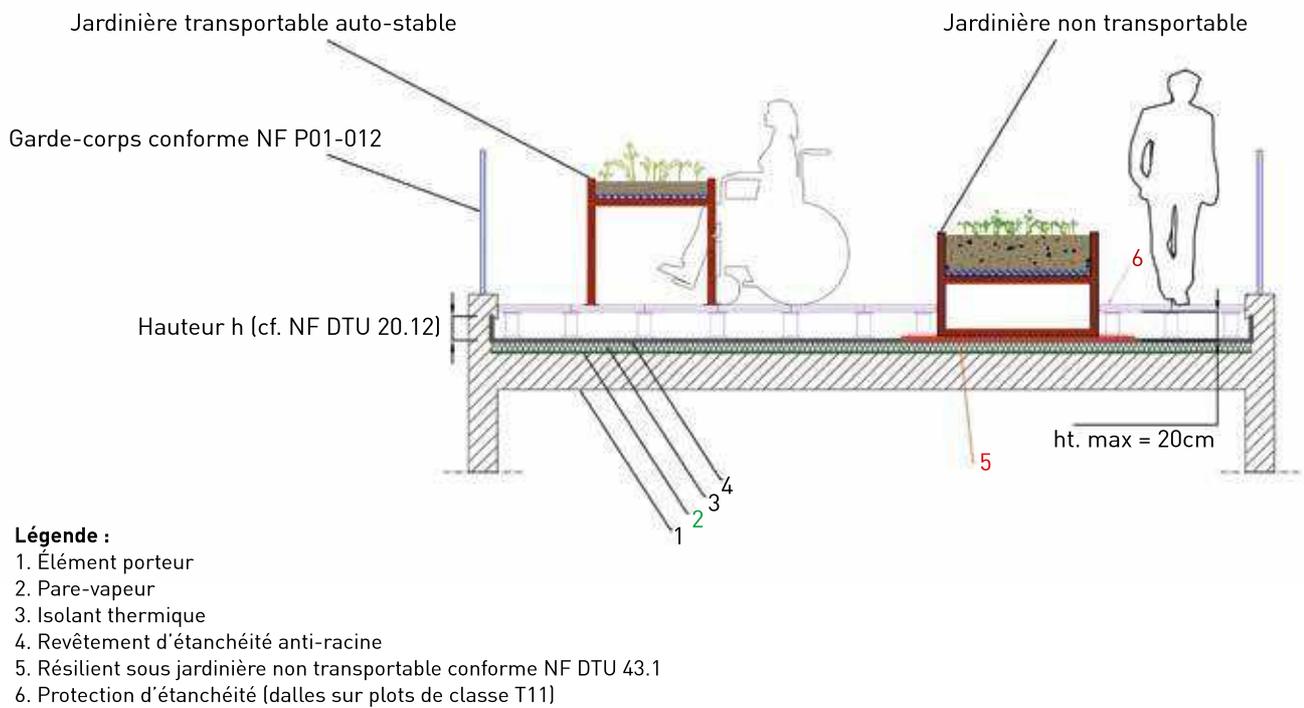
Coupe de principe de bacs et jardinières sur toiture-terrasse accessible au public
